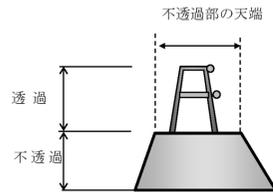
部分透過型砂防堰堤越流部側面図(例)
